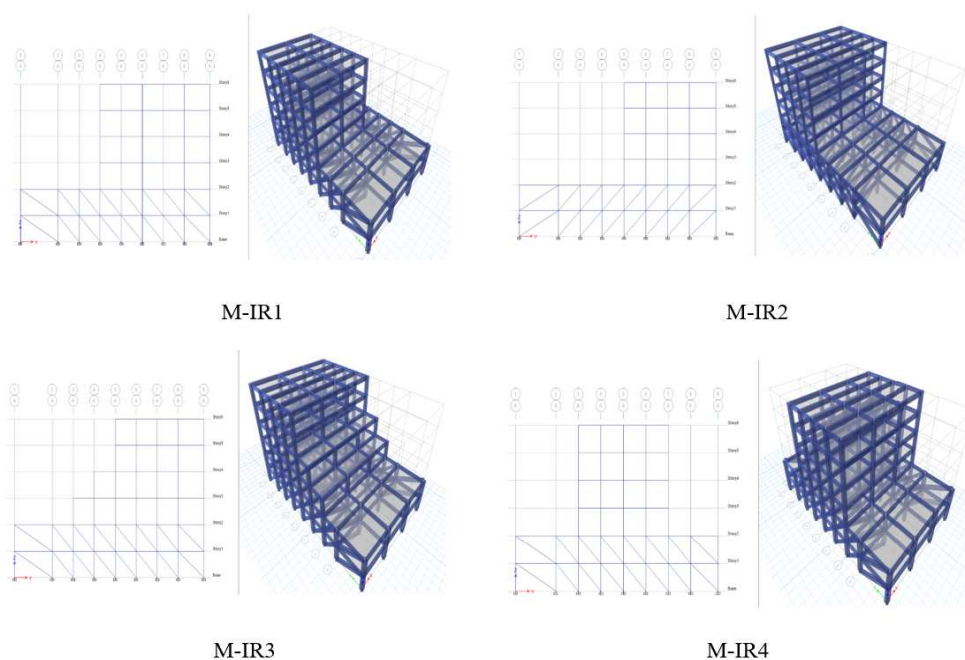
Geometriile structurilor din beton armat cu retrageri luate în considerare în studiul de față
